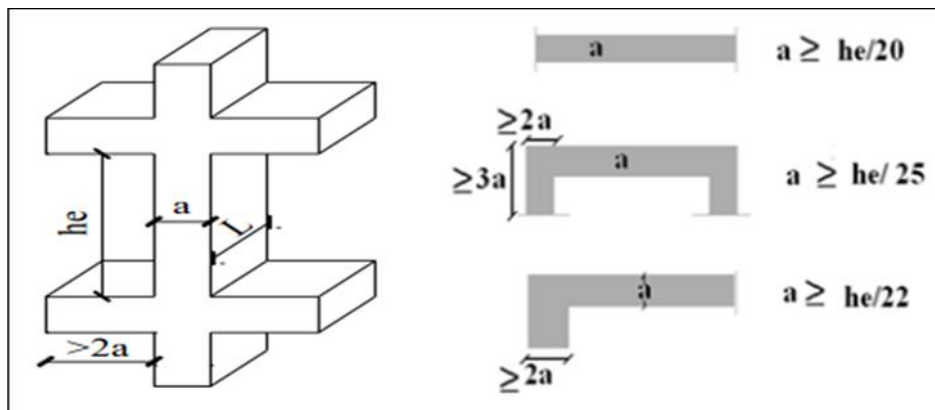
Coupe de voile en plan (droite) Voile en 3D (gauche).
